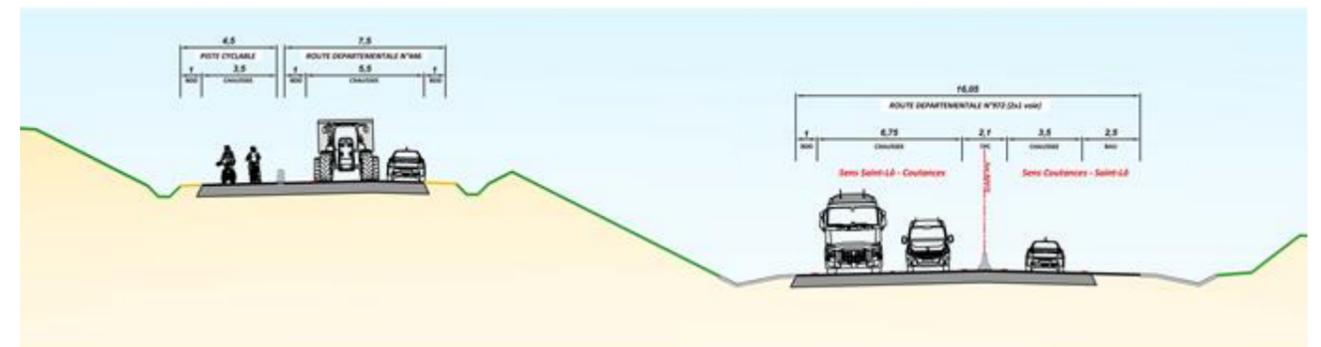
Profil en travers de la voie verte entre le hameau « La Saunerie » et St-Gilles
